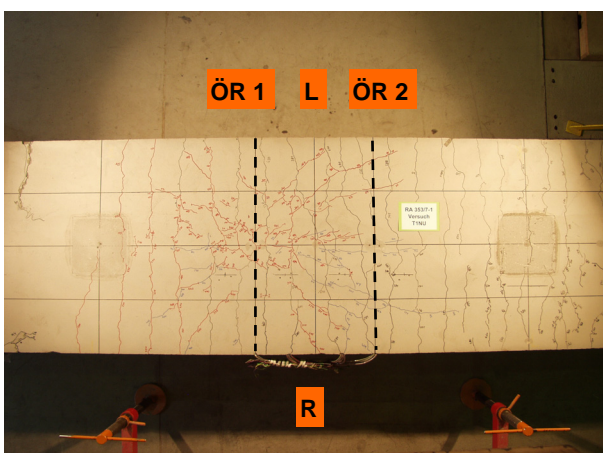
Rissbild auf der Betongurtoberseite
